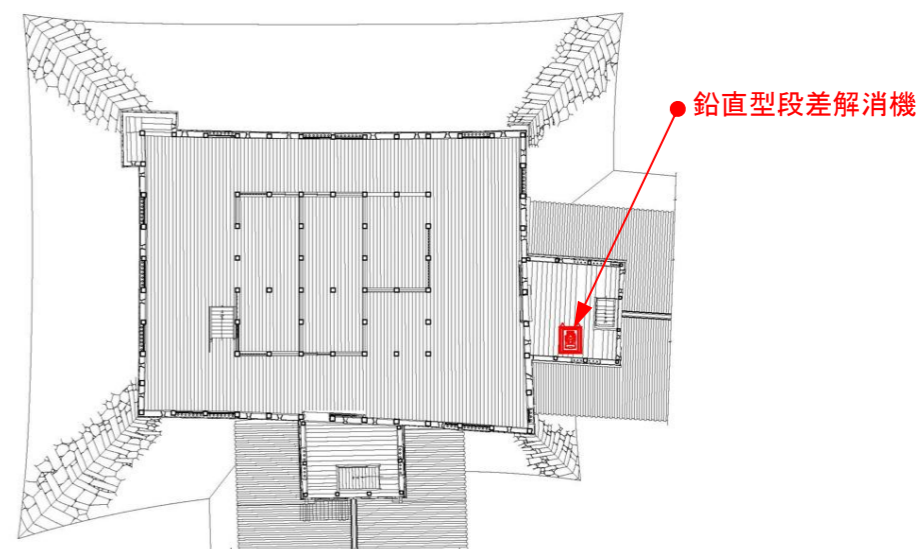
天守 1 階平面図及び東廊下・南廊下 2 階平面図（復元原案）
